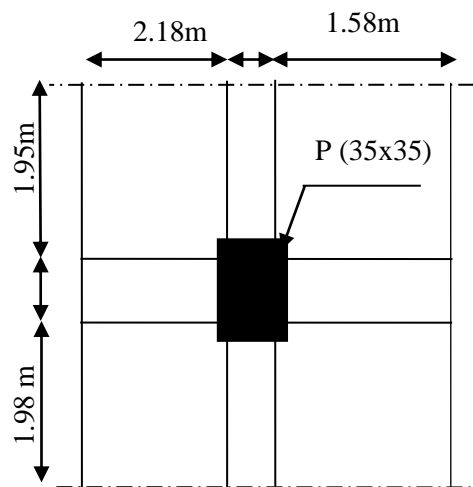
Surface revenant au poteau central du niveau étage 2 à 6 (poteau B2)
